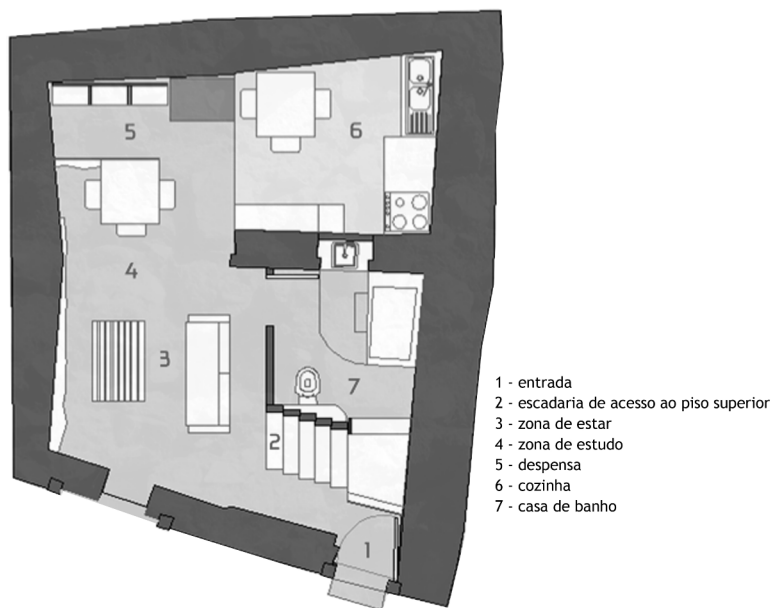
Planta de zonamento do piso inferior em desenvolvimento
